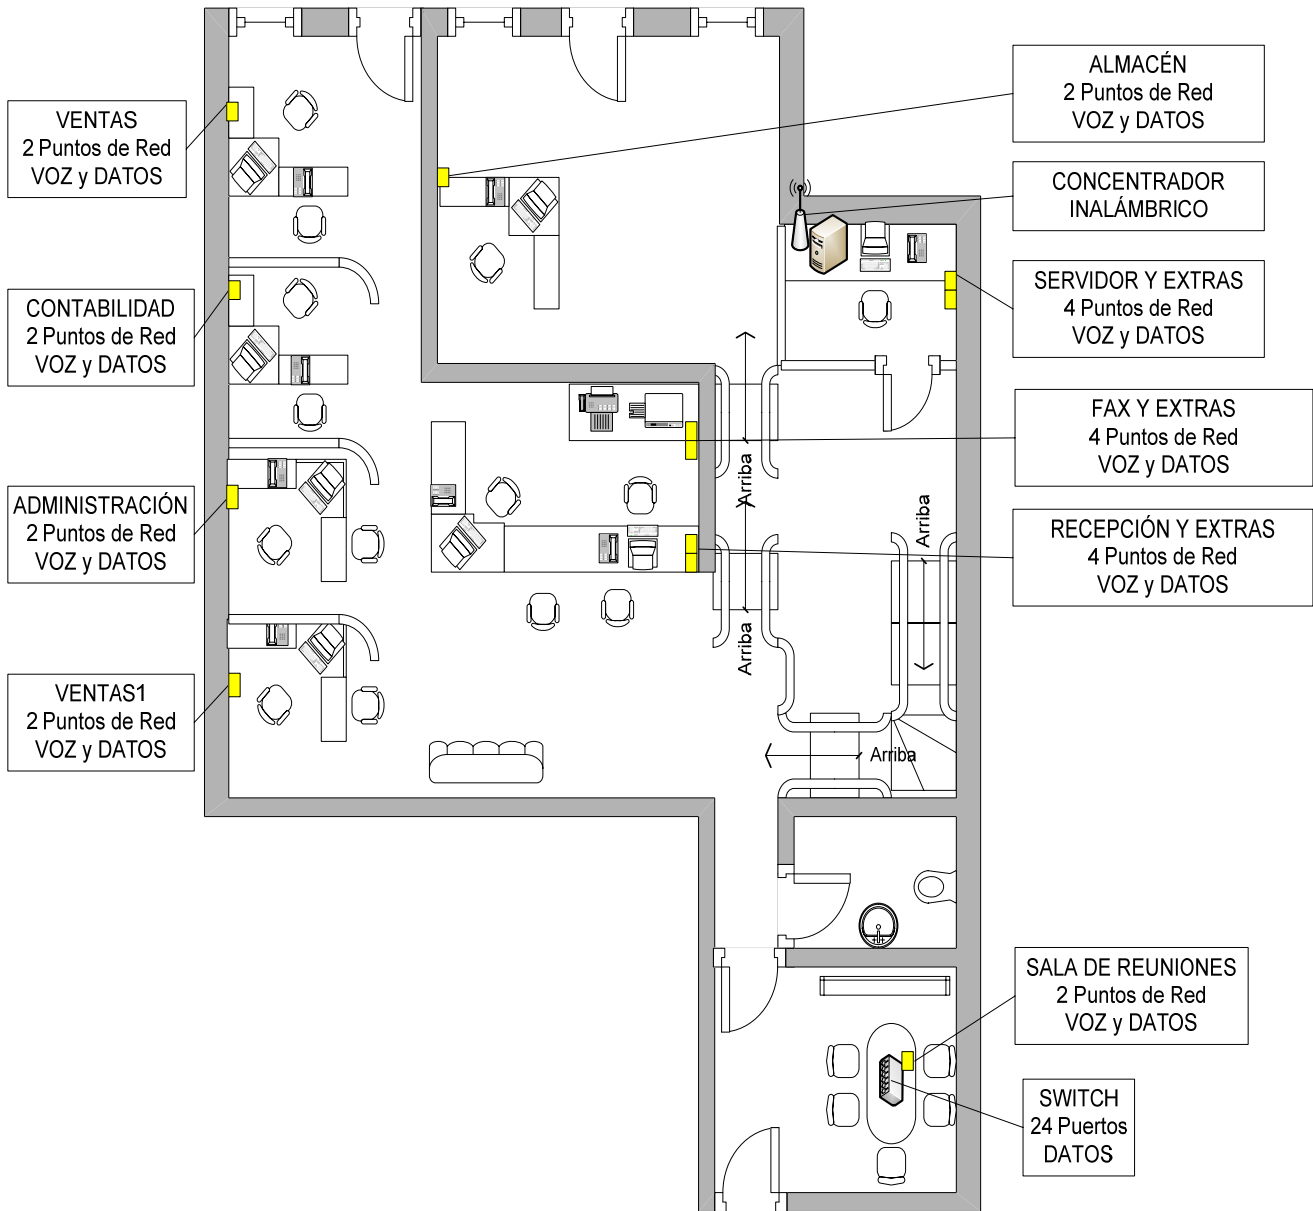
Plano Puntos de Acceso Planta Baja.
